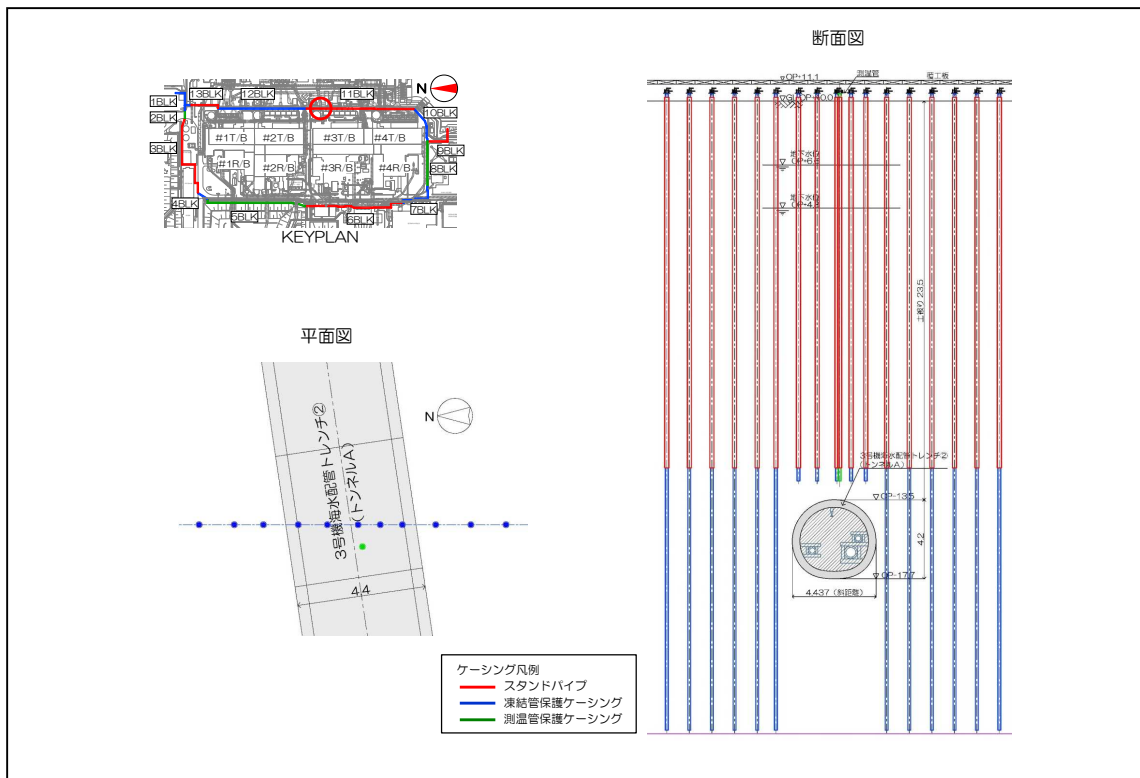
3号機海水配管トレンチトンネルA部 施工平面図・断面図
